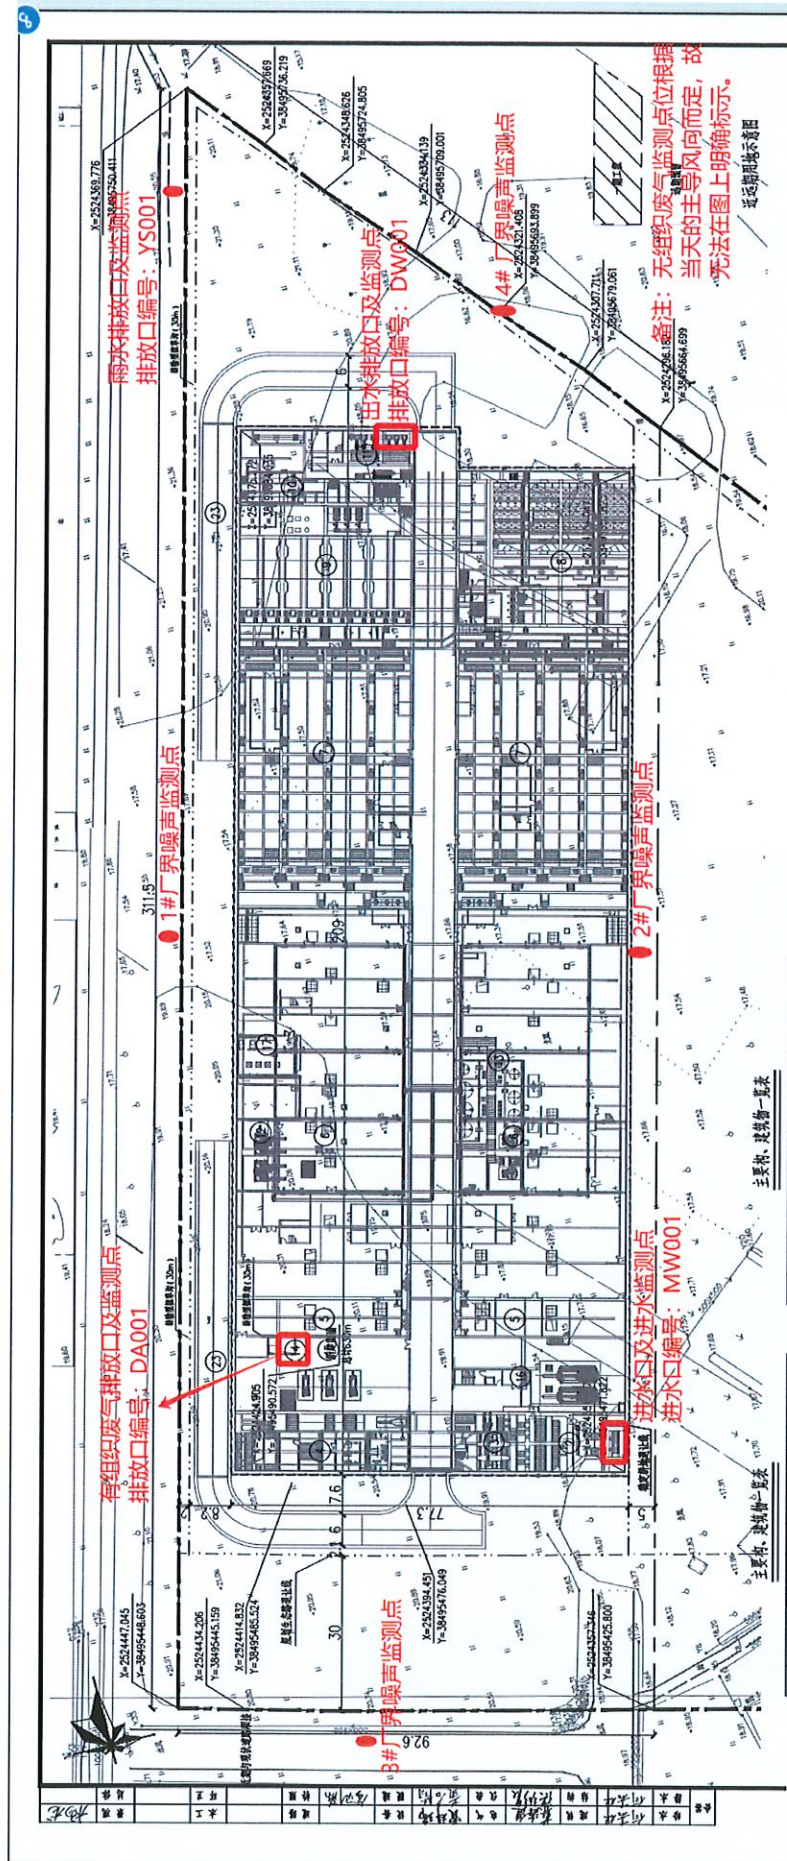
本项目废气、废水、噪声监测点位布置示意图
